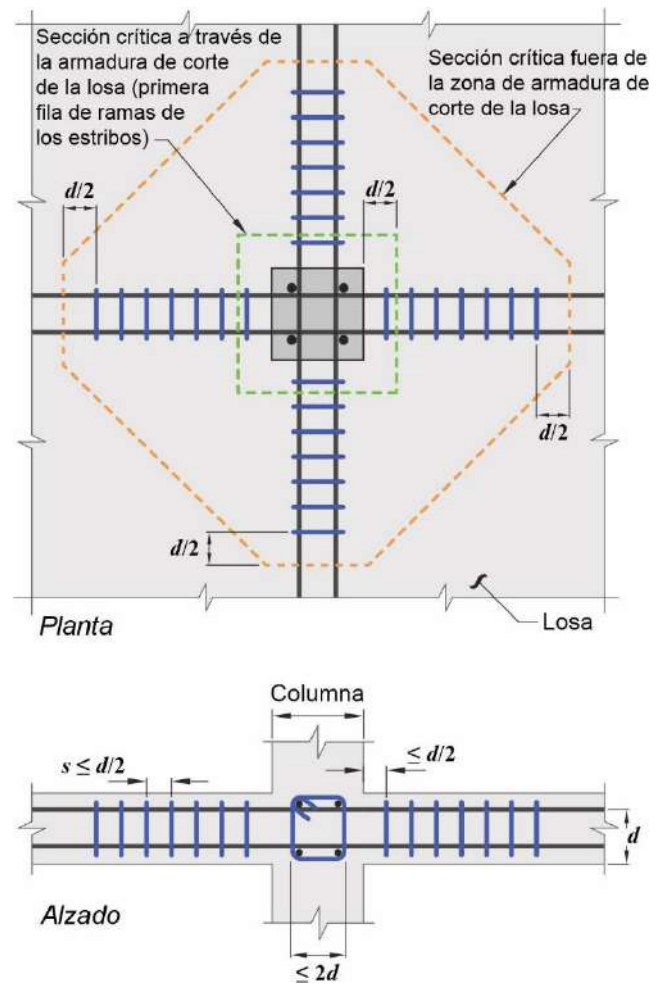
(d). Disposición de estribos de corte, columna interior
